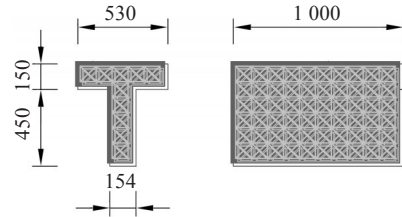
初始T梁钢筋混凝土分离模型几何参数 (单位: mm)
